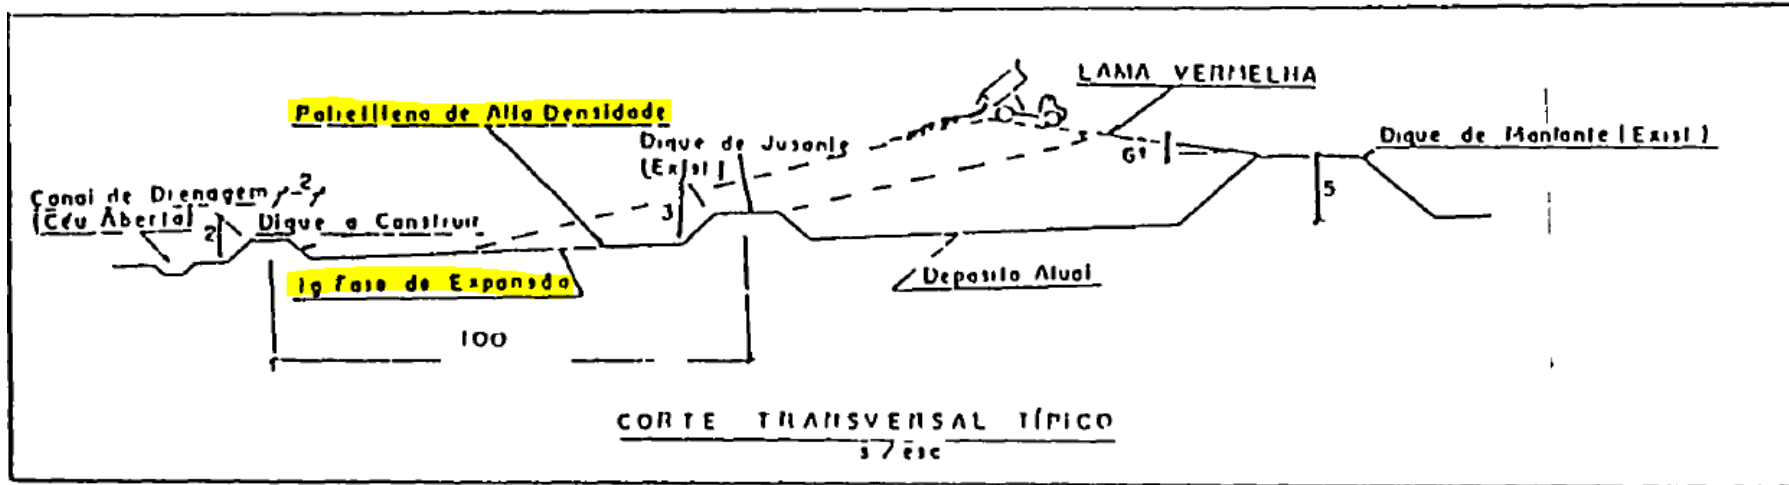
Vista em perfil da 1ª fase de expansão do DRS1, com destaque para a utilização de PEAD como material de impermeabilização (adaptado de CI-RAE-086/96)
